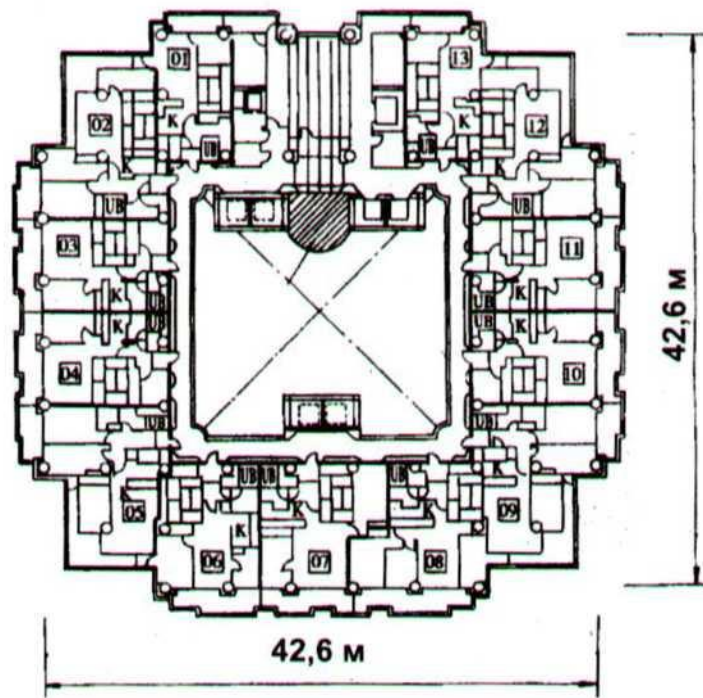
План житлового висотного будинку з трубобетонних колон в м Кавачугі, Японія
